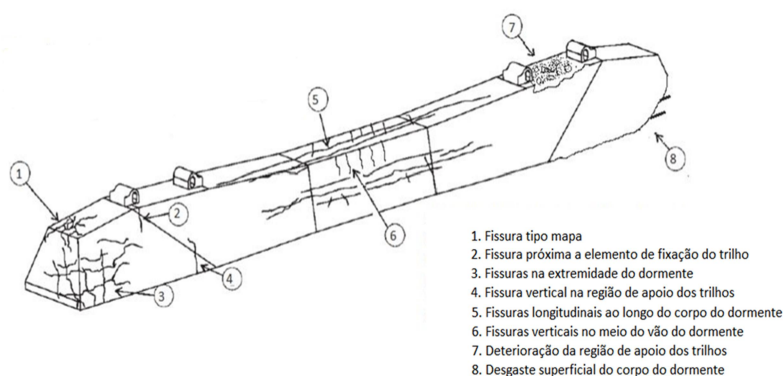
Categorias mais comuns de fissuras identificadas em dormentes de concreto protendido
